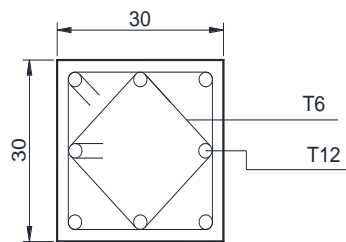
Ferrailage d'un poteau 30x30cm (poutres noyées - plan fortement irrégulier)
